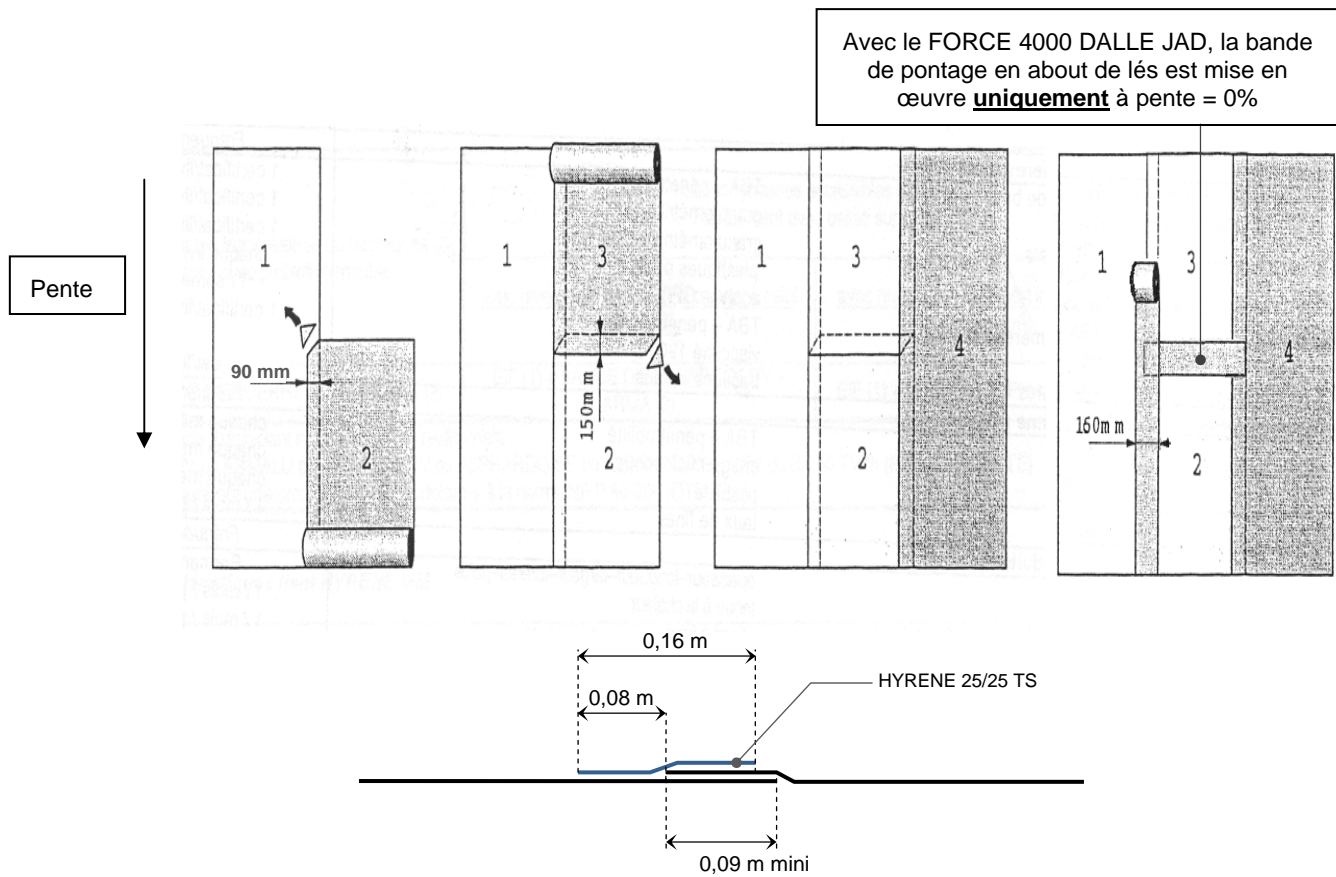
Traitement des joints (coupe des angles et pontage) pour les feuilles FORCE 4000 DALLE – pente = 0%
